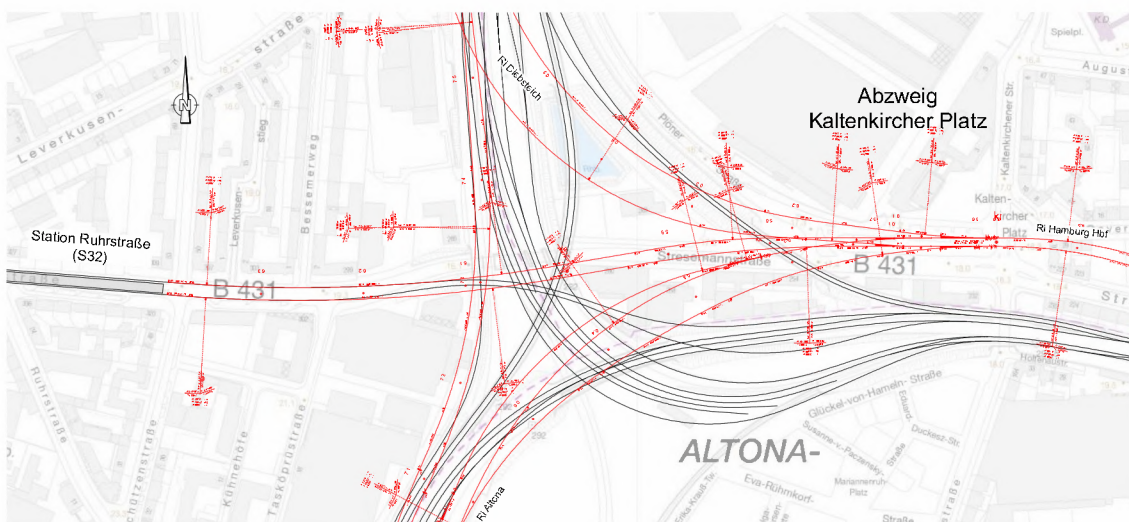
Lageplan Anschluss S32 bei Station Ruhrstraße
